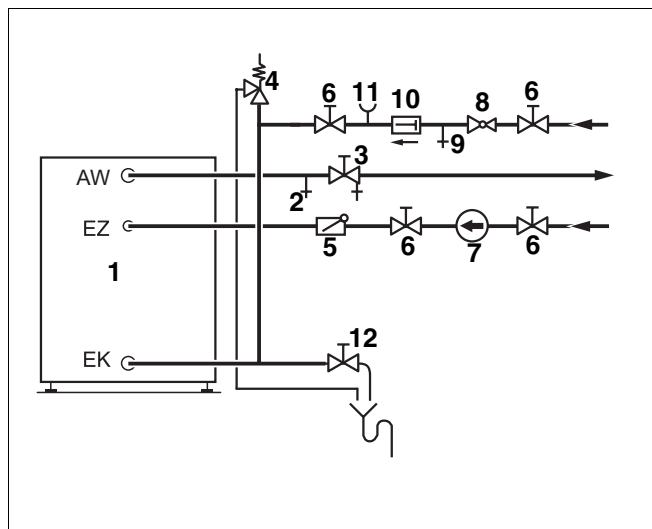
Installazione secondo la norma DIN 1988 (illustrazione schematica)
